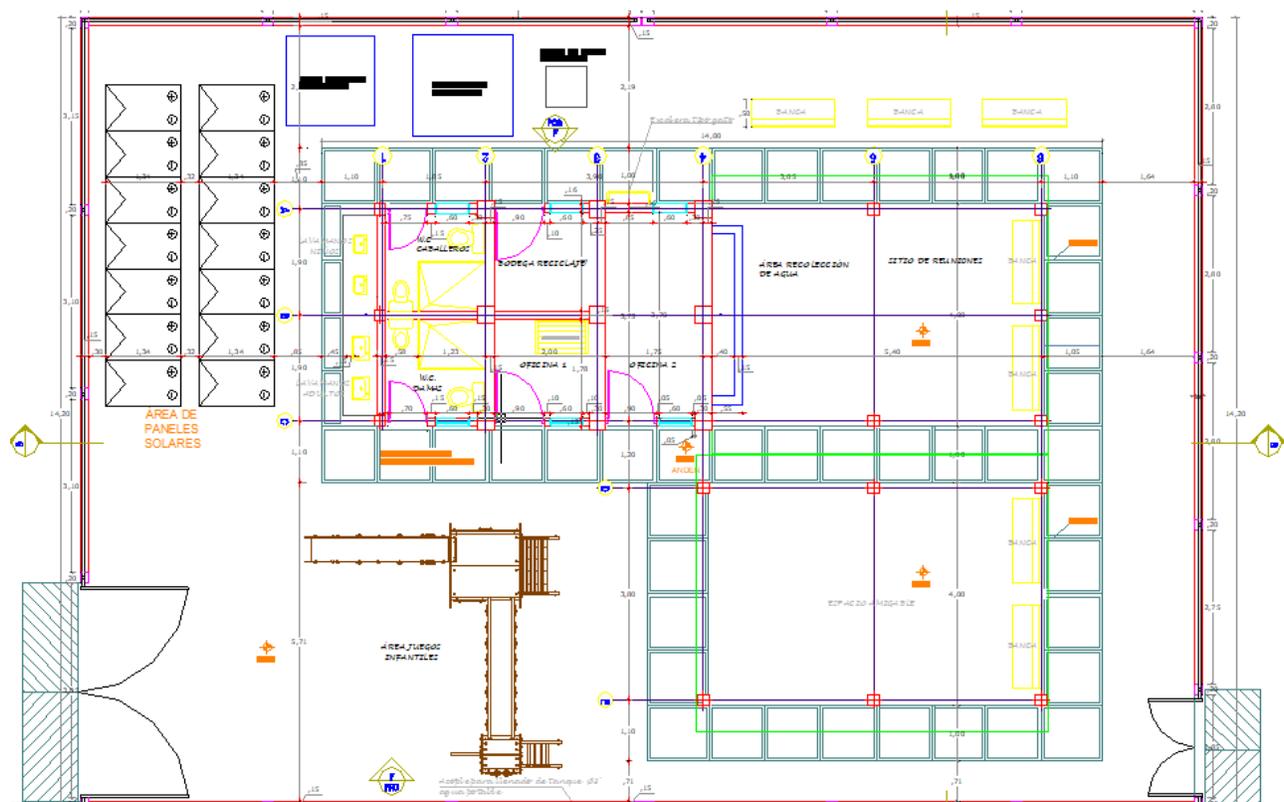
Planta Arquitectónica Pila Publica (Fuente: MVCT)
